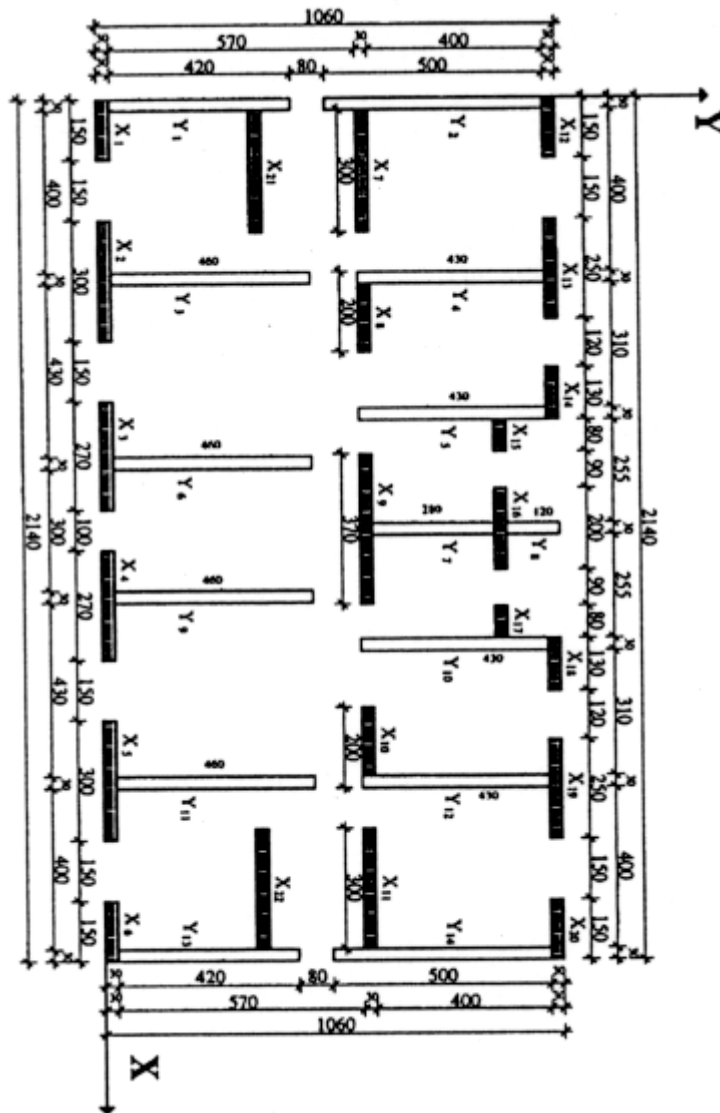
Disposizione planimetrica dei setti portanti.
